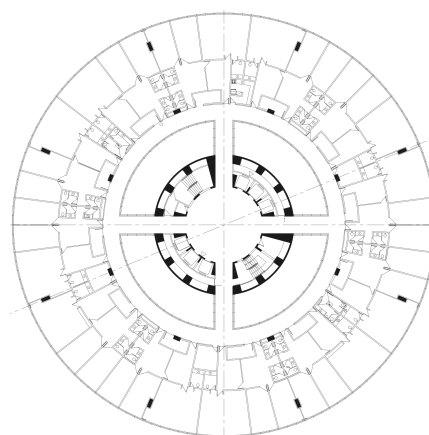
Planta do pavimento tipo, bloco A; Fonte: Arquivo da PGR
